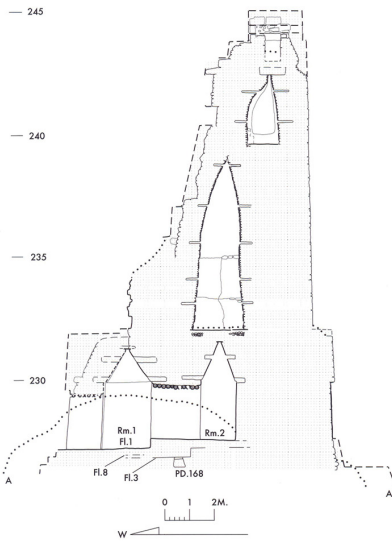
Sección de la crestería del Templo VI de Tikal según S. Loten (2017). Se observan las huellas de los morillos en las cámaras de aligeramiento de la crestería.
